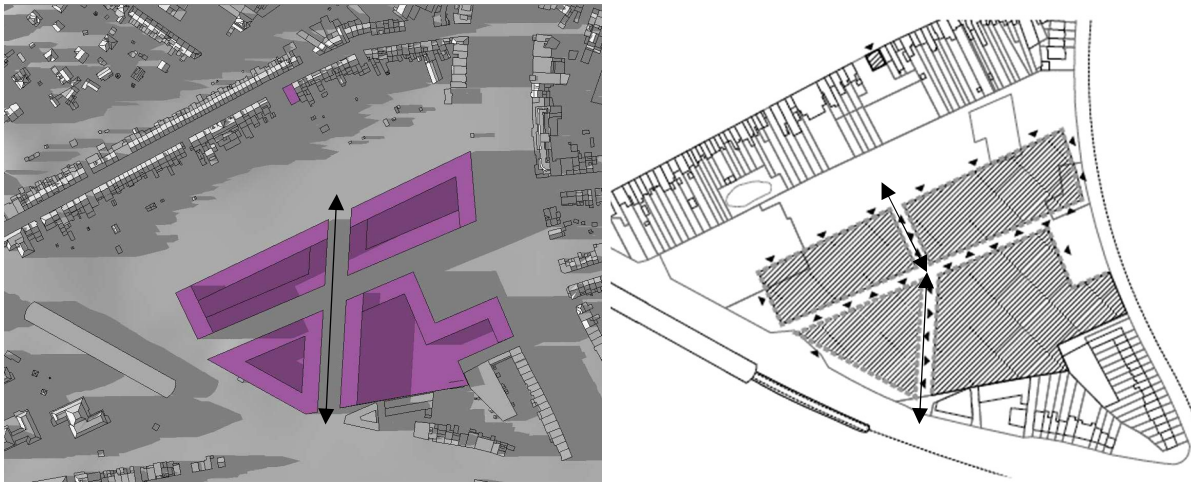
Comparaison entre la 3D (gauche) et le plan (droite) (ORG², 2018)
